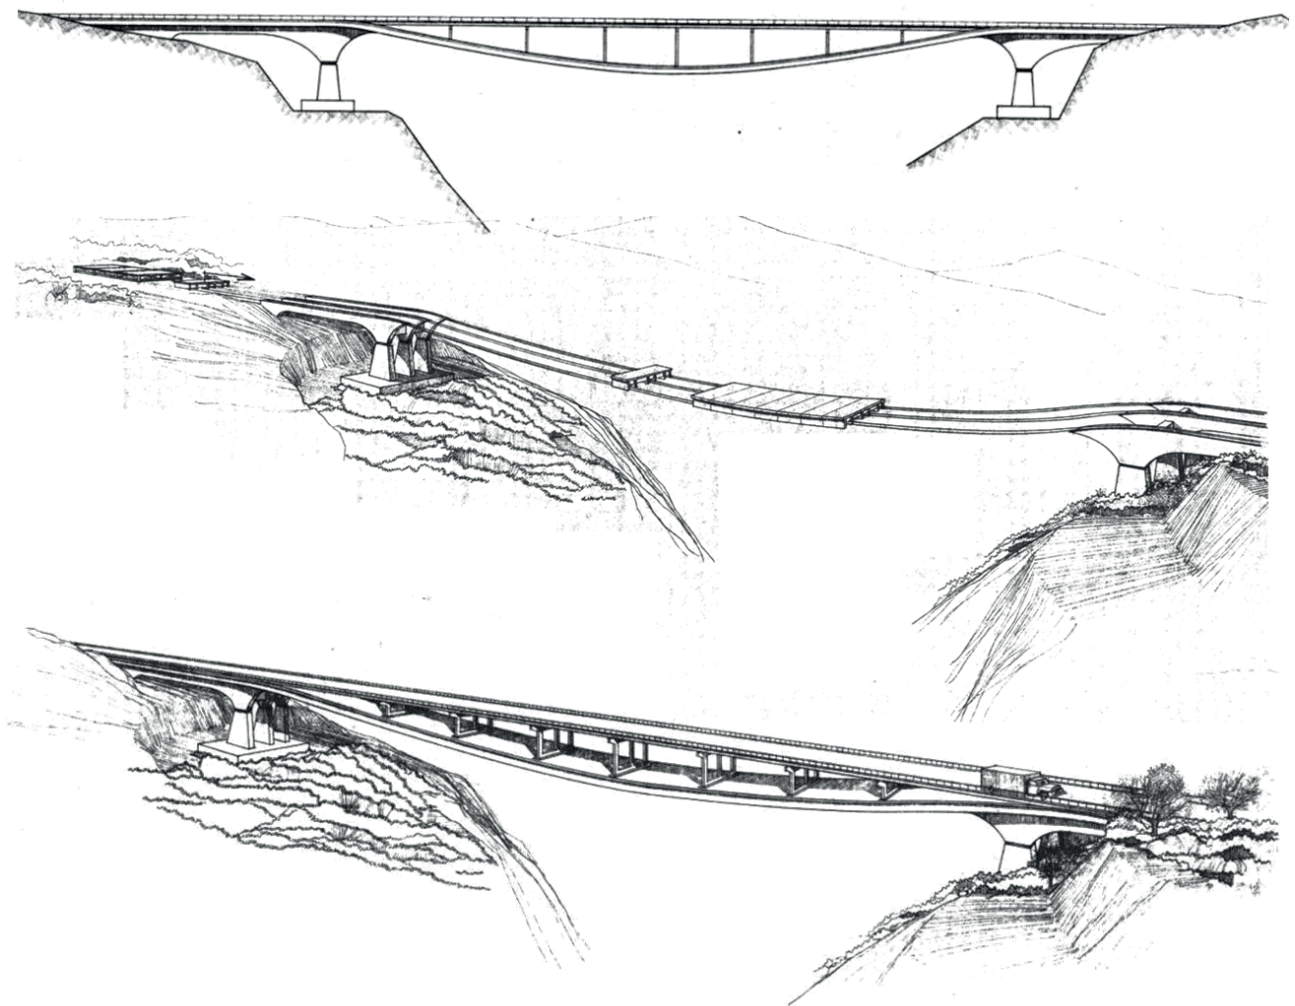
Alternativa elegida de puente tipo “viga-suspendida” para el puente sobre el río Colorado. Notar que las pilas que soportan el arco invertido de concreto inicialmente serían verticales. (Modificado de planos de anteproyecto de T.Y. Lin Internacional, 1968).
